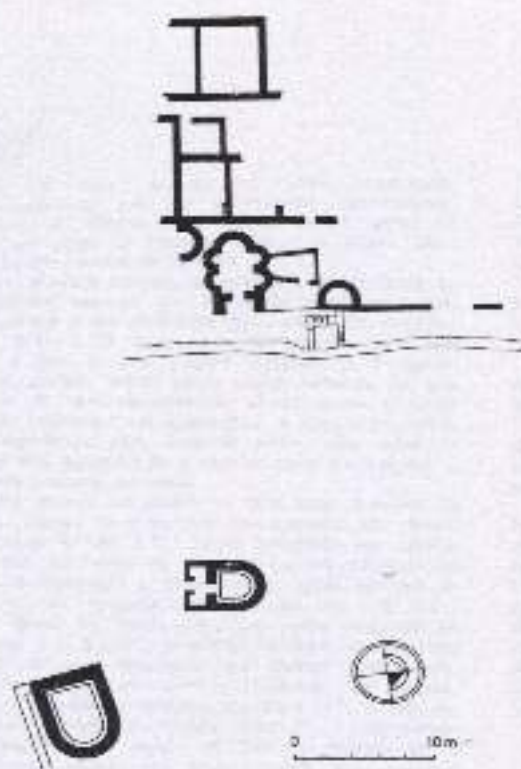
Quinta do Martin (8/311) Planta da villa. (The villa)
